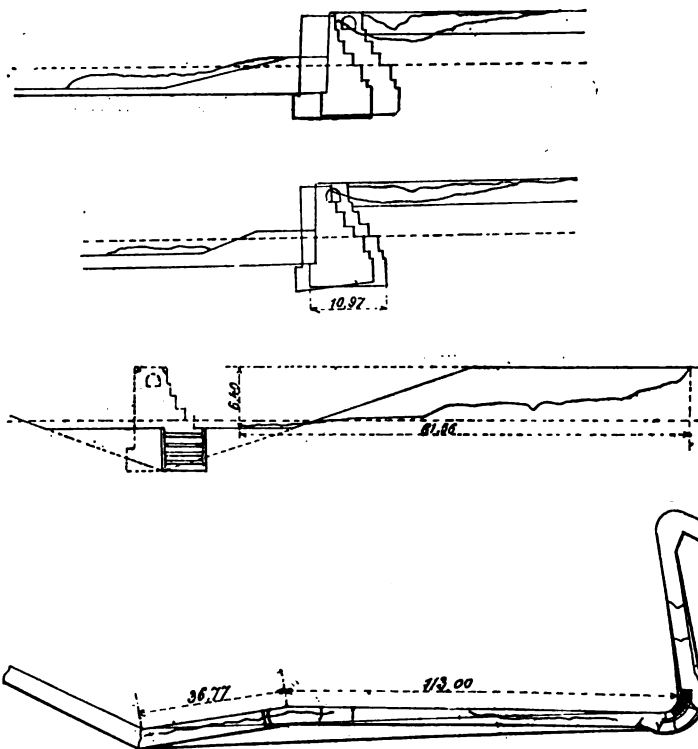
Kidderpur Dock. — Plan et coupes du quai écroulé.
